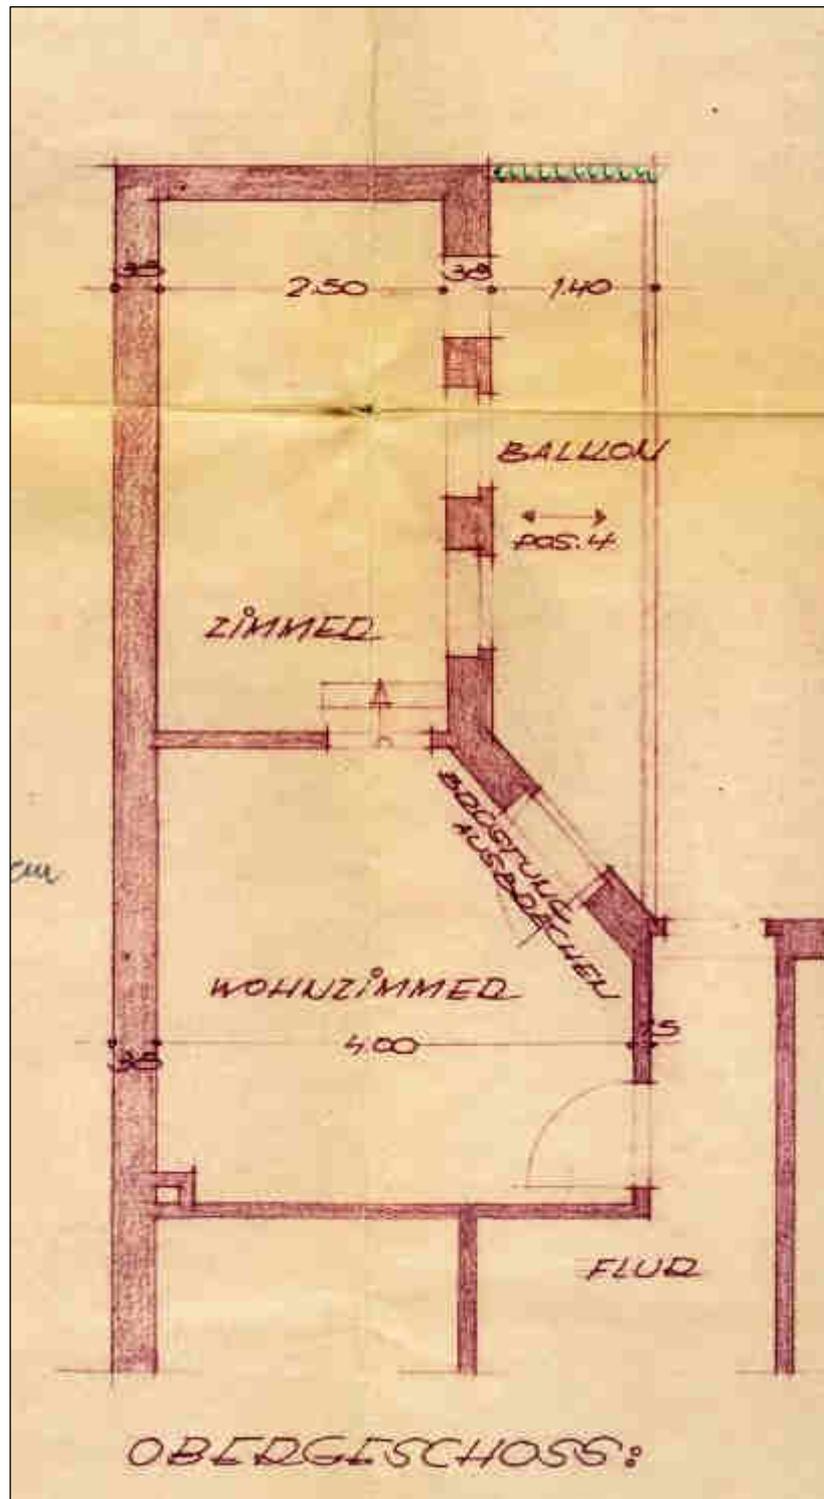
Grundriss Obergeschoss Anbau. Zimmer = Bad
